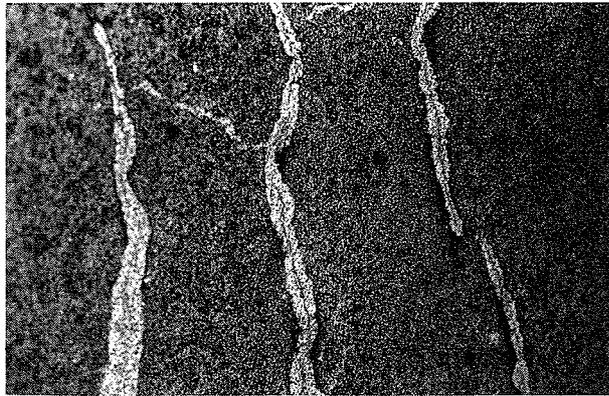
鉄筋コンクリート造建物の外壁の亀裂に沿ってつくられたイエシロアリの蟻道跡
